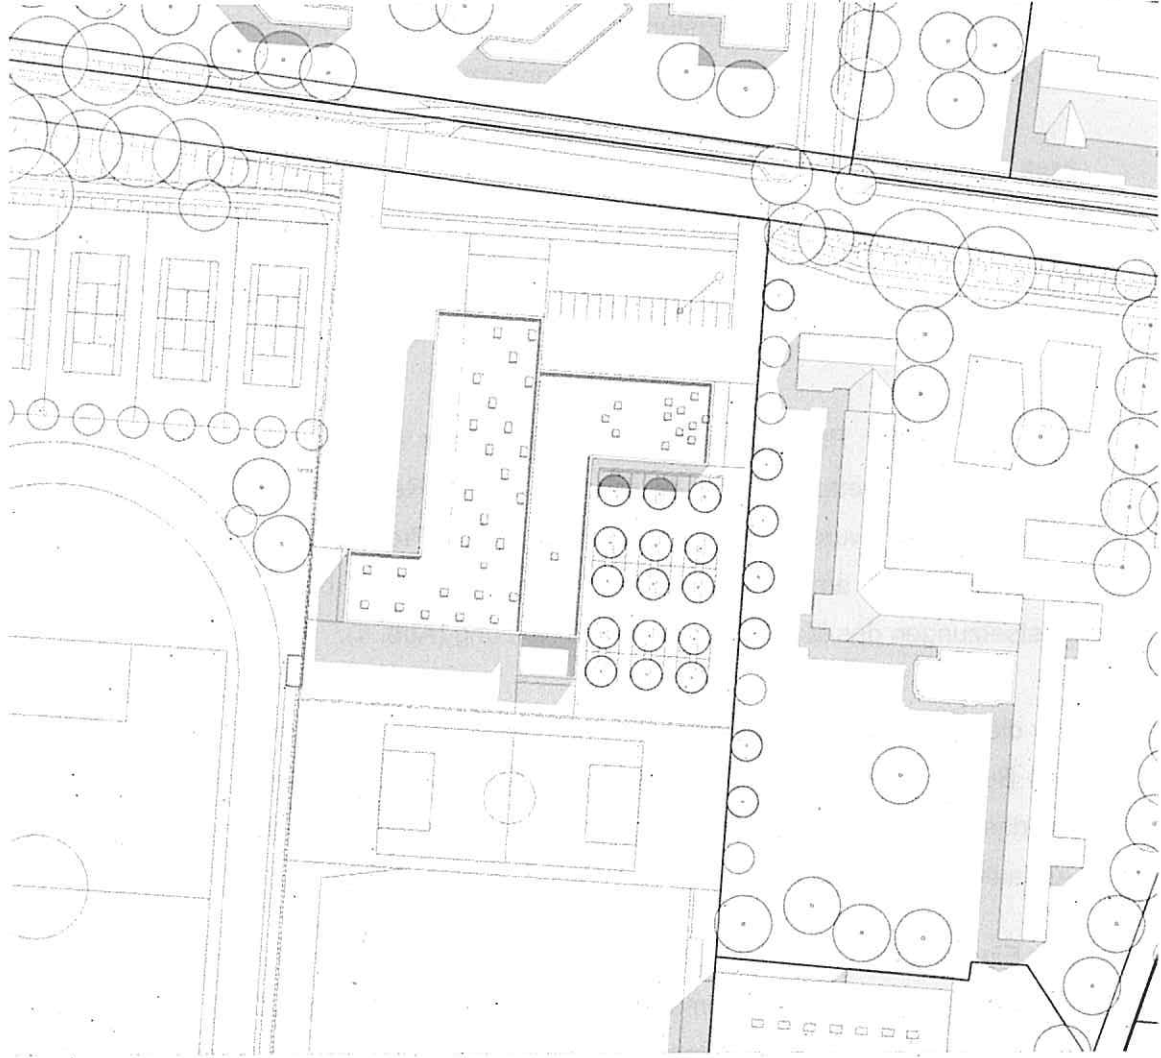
; Lageplan des geplanten Feuerwehrhauses - ohne Maßstab -
